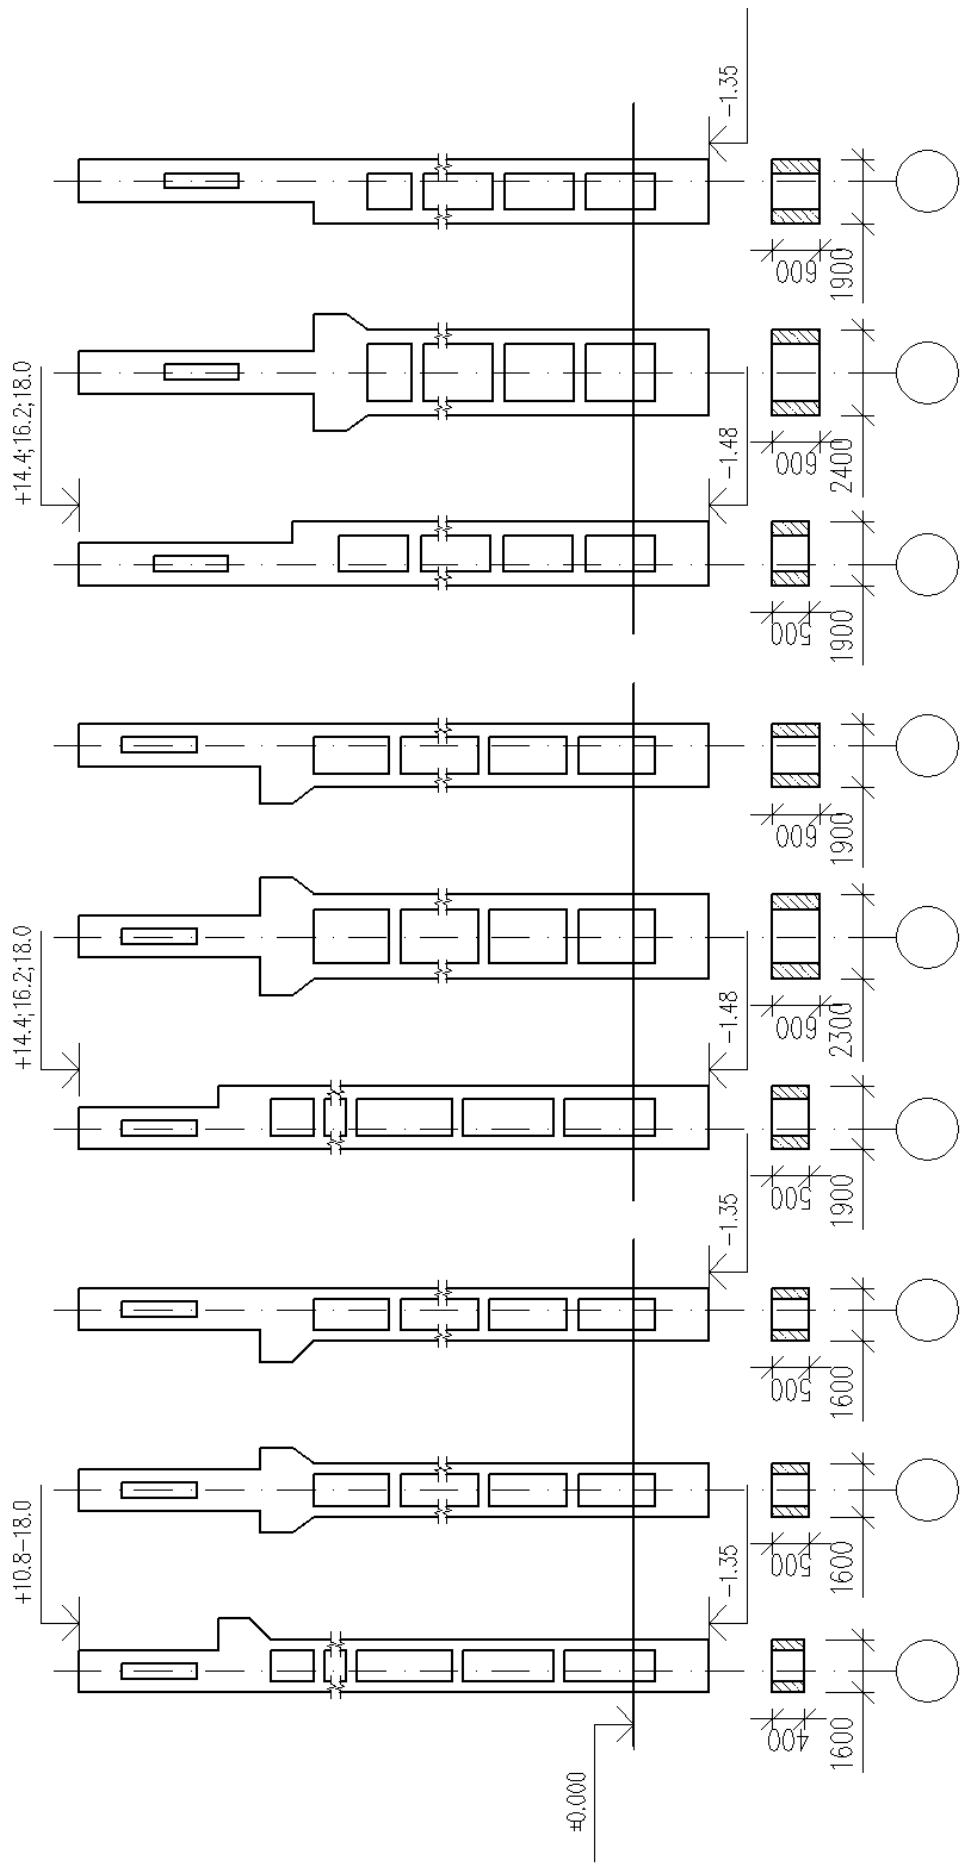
Железобетонные двухветвевые колонны для зданий с кранами грузоподъемностью 10 – 75 т и с проходами в уровне подкрановых путей (серия КЭ-01-60)
